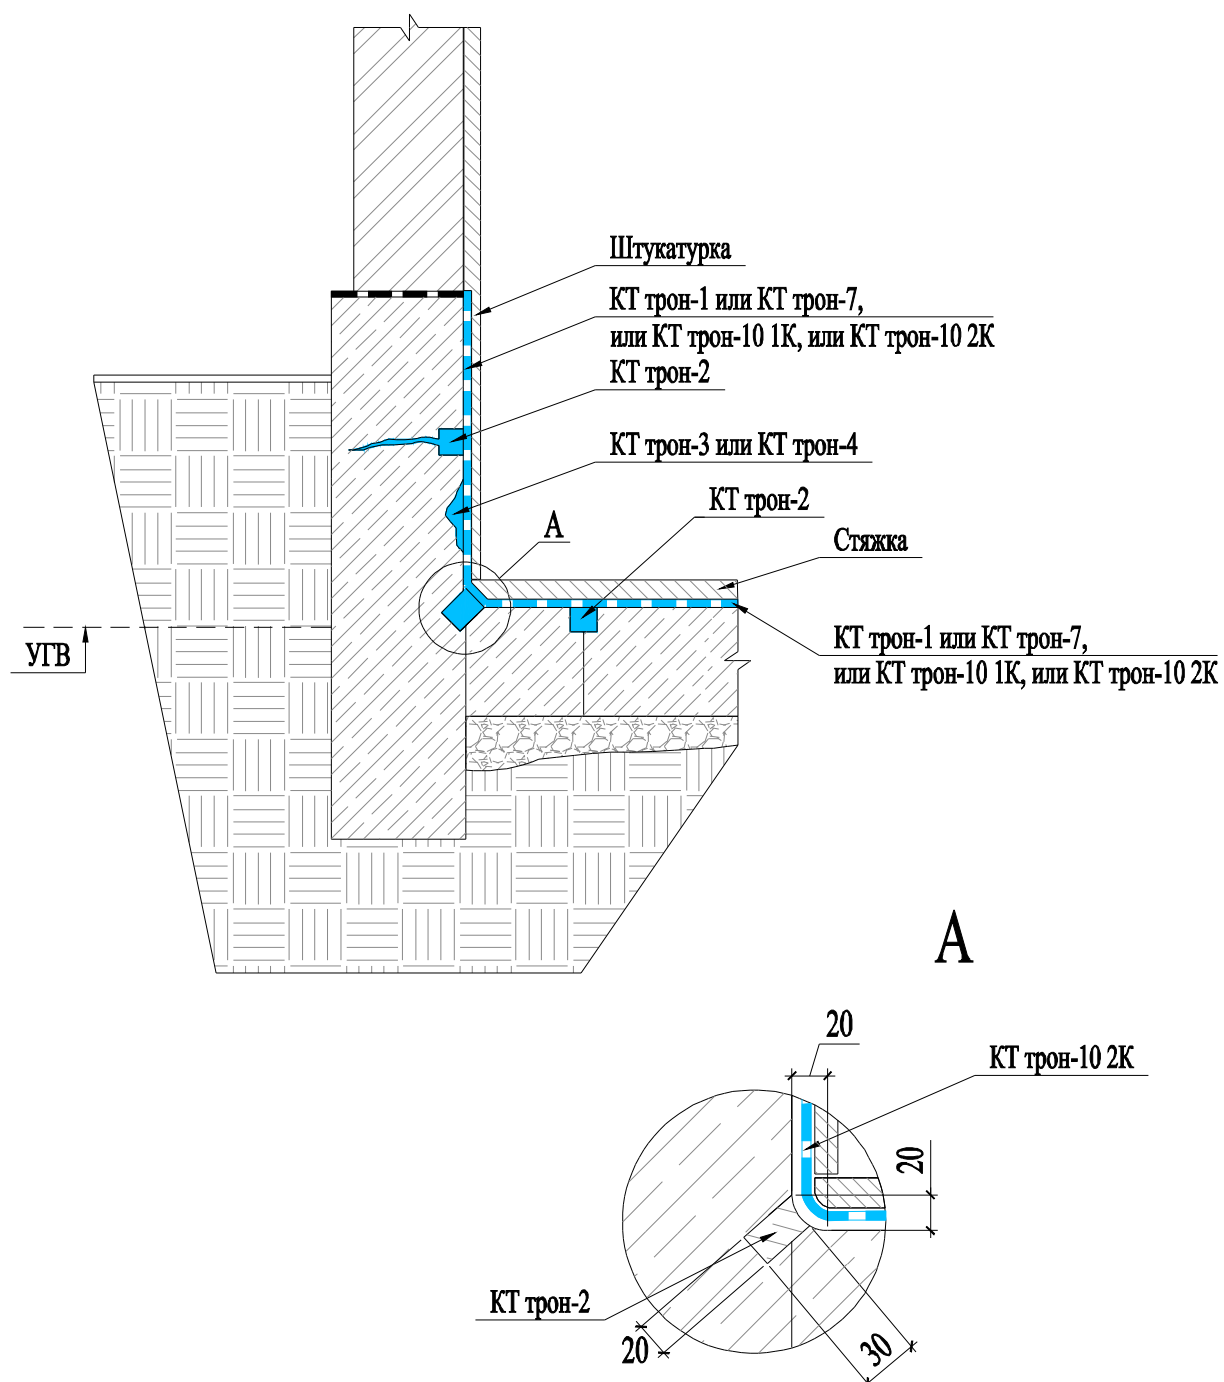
Схема гидроизоляции фундамента из монолитного бетона
